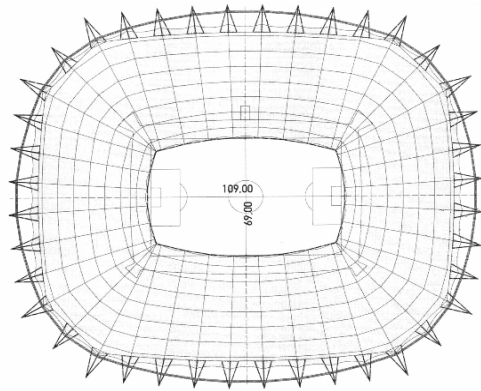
Grundriss des Volksparkstadions in Hamburg; aus /3/
